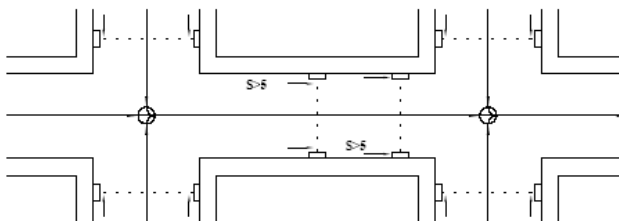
Ubicación de coladeras longitudinales de banqueta
